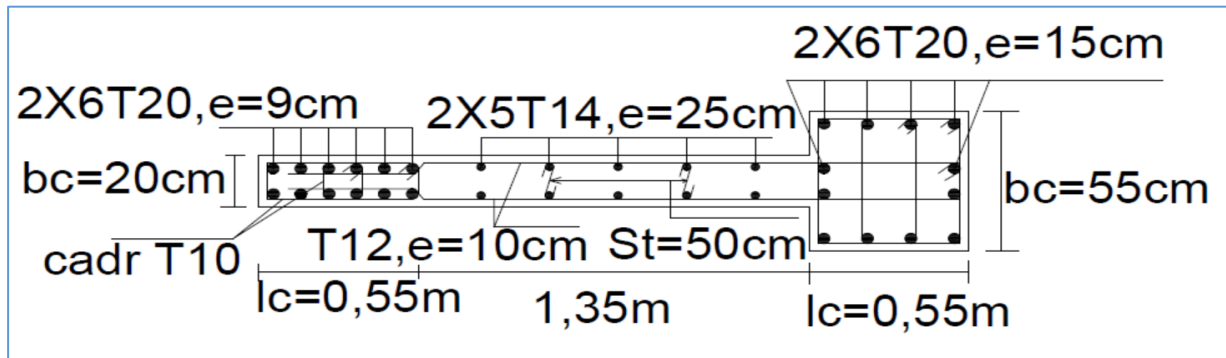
La coupe de ferrailage des voiles sens x épaisseur 20cm.
